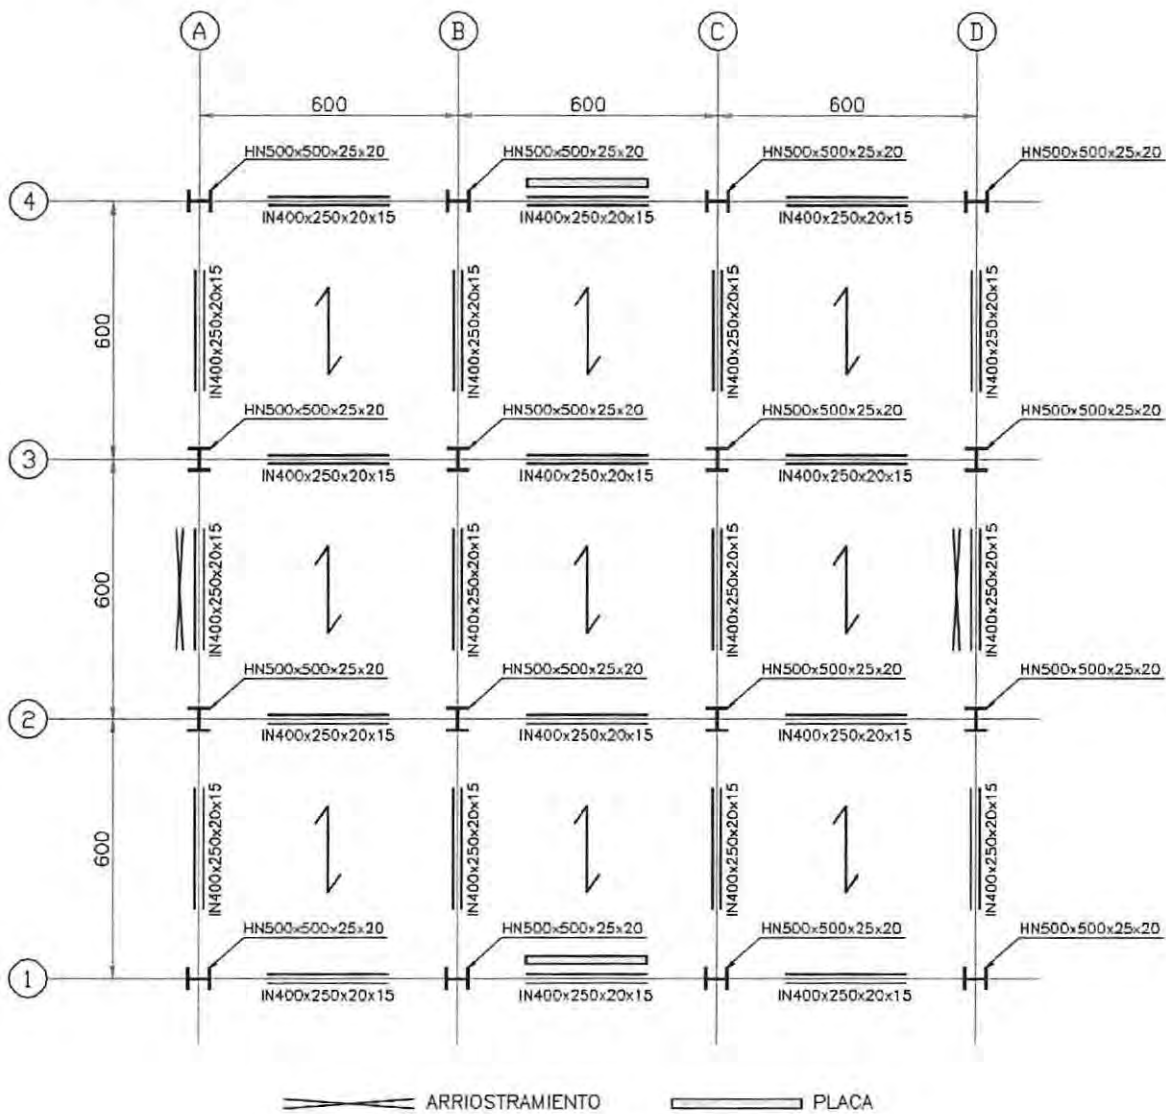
Planta de estructuras tipo del edificio rehabilitado.
